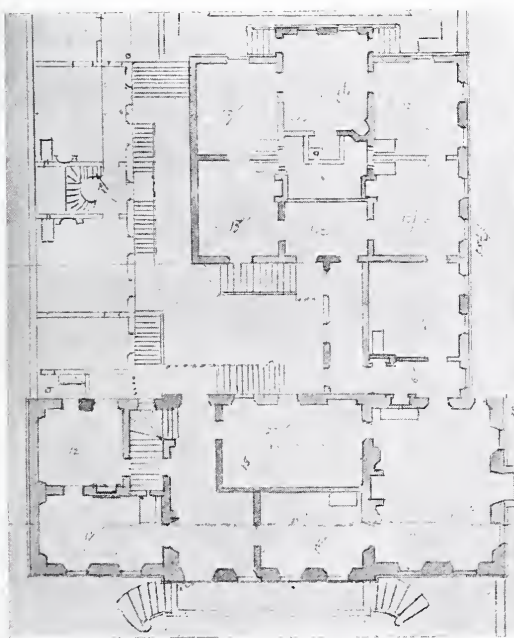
Grundriss des zweiten Winterpalais.
